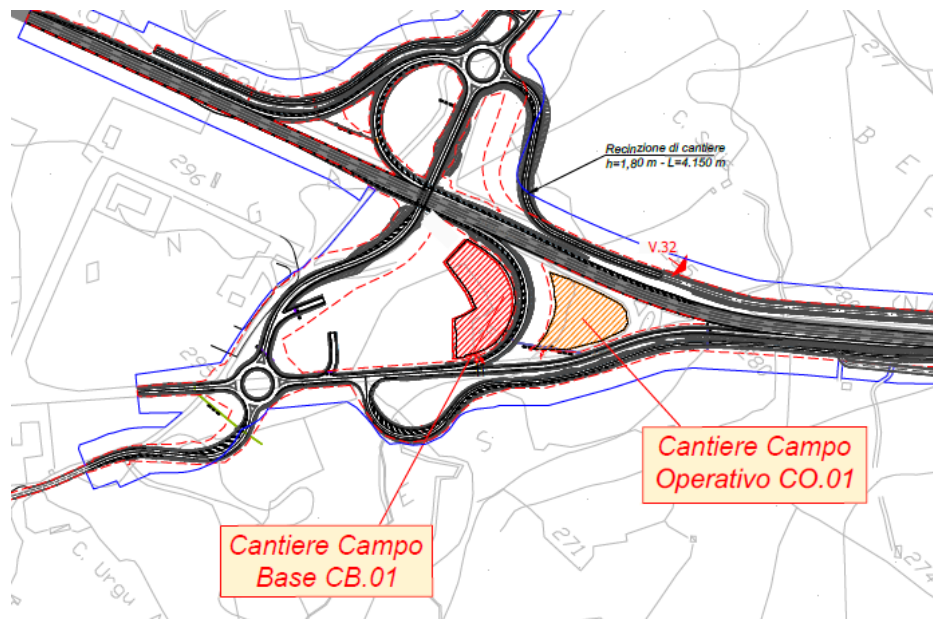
Stralcio planimetria localizzazione aree di cantiere e viabilità di servizio
